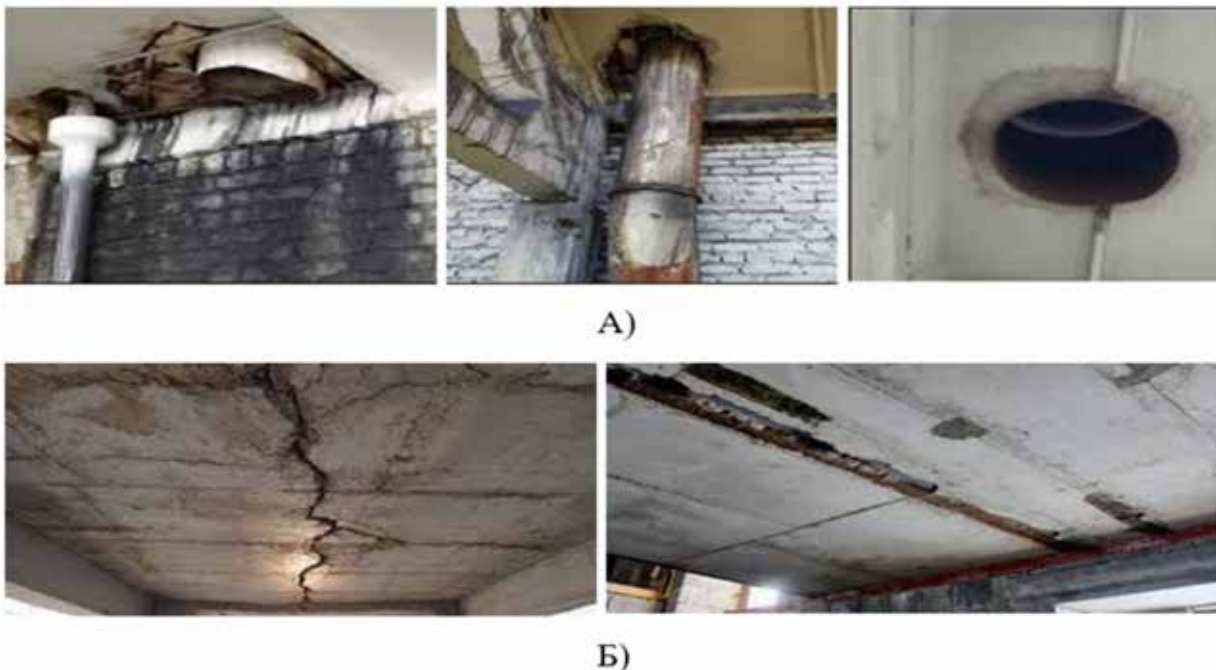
Дефекти монолітних залізобетонних плит перекриття: А) механічне руйнування бетону плит з оголенням арматури у місцях прокладання комунікацій; Б) тріщини
